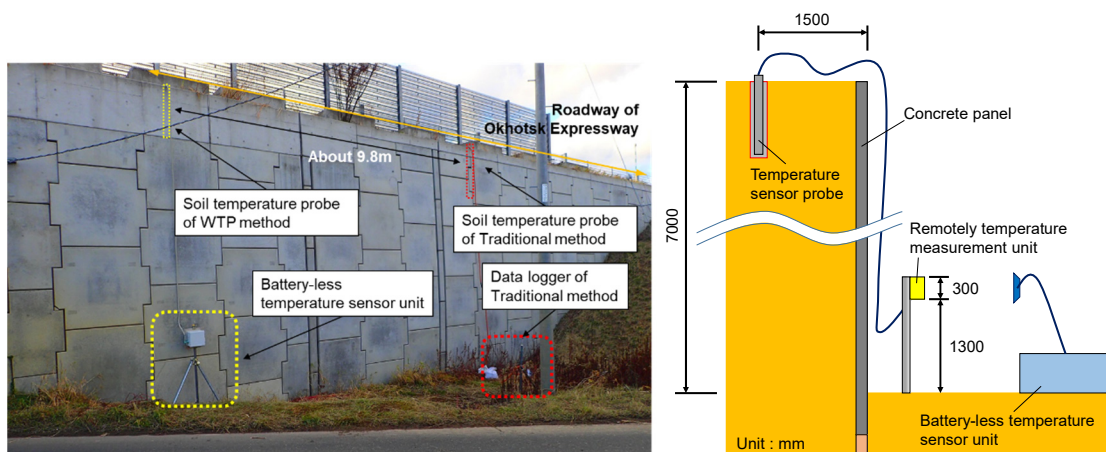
Site-2 の補強土壁の全景と計測機器の配置図
